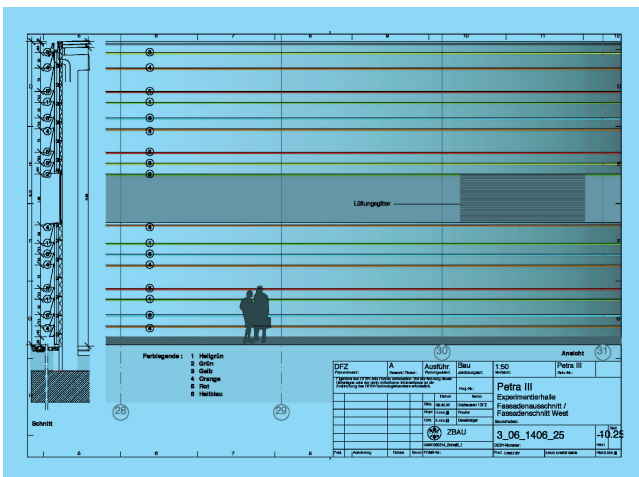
PETRA-III-Experimentierhalle, Plan der Fassade.
